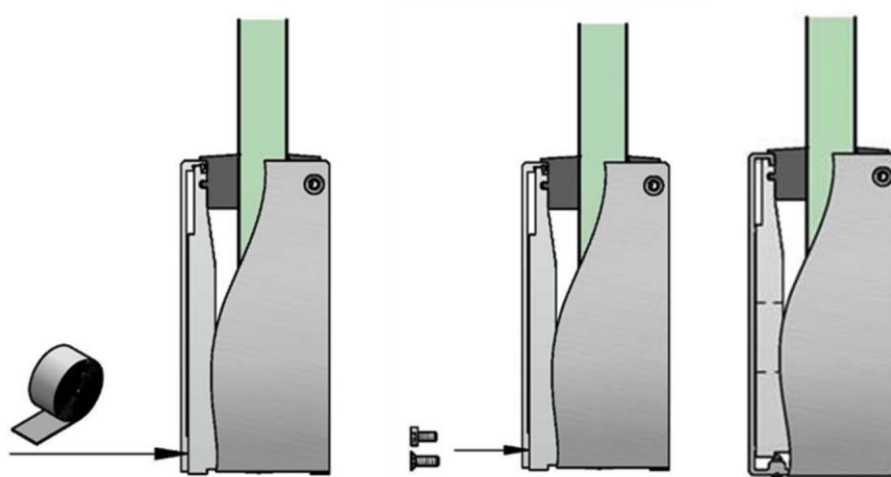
Fixation de la tôle d'habillage sur le profilé de maintien CROSILUX 2.0 sur dalle et en nez de dalle
